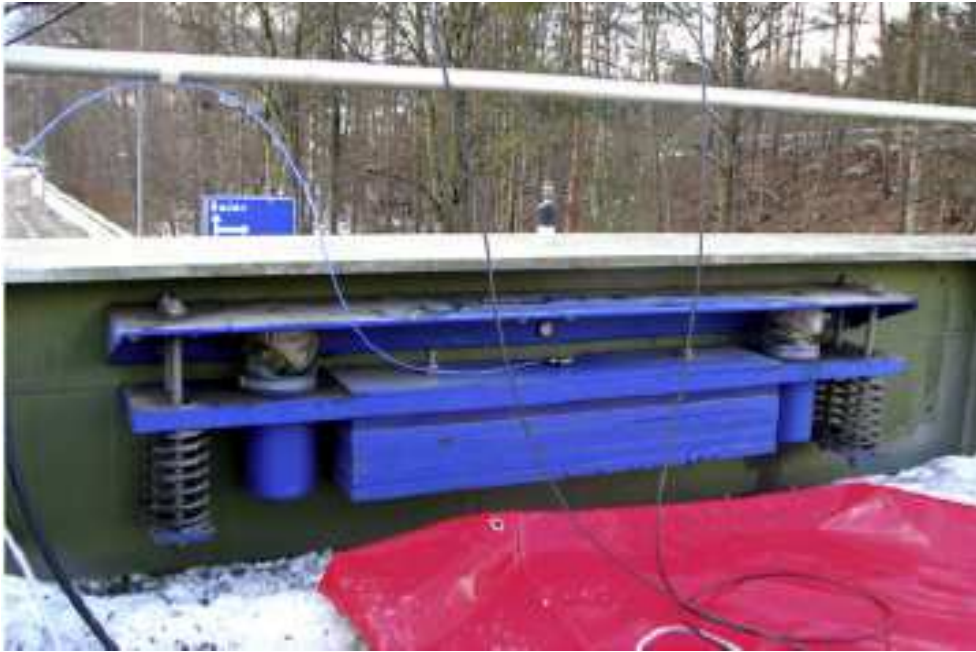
Amortecedor de massa instalado na passarela com sistema estrutural em viga (Suíça) [29].
